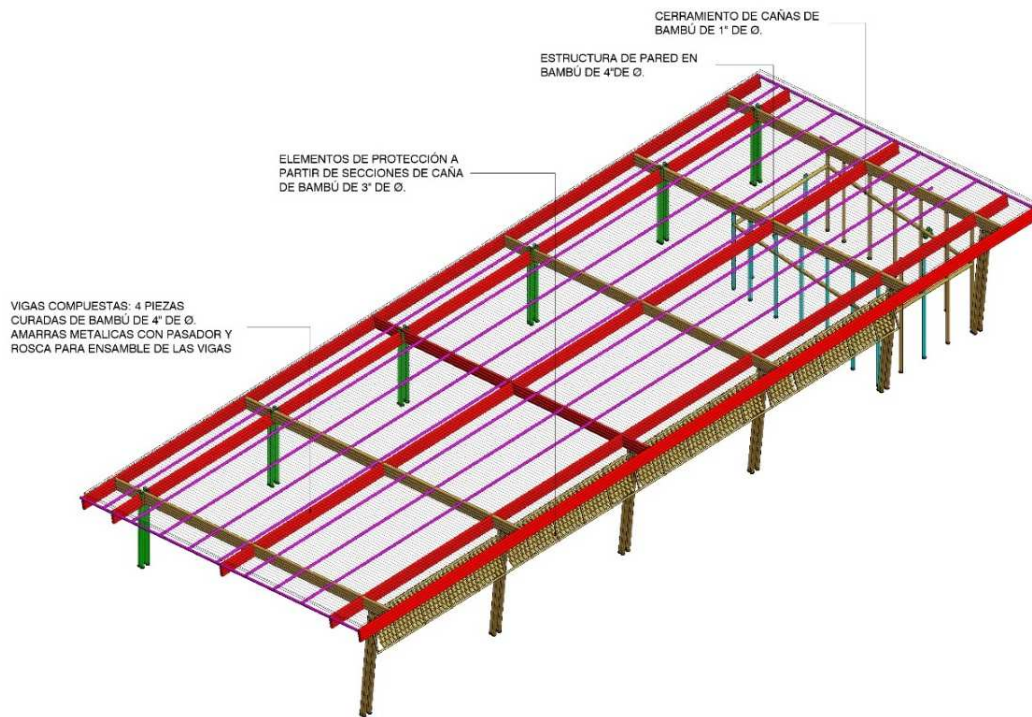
Esquema estructural cubierta en bambú. Fuente: Elaborada por el autor.
